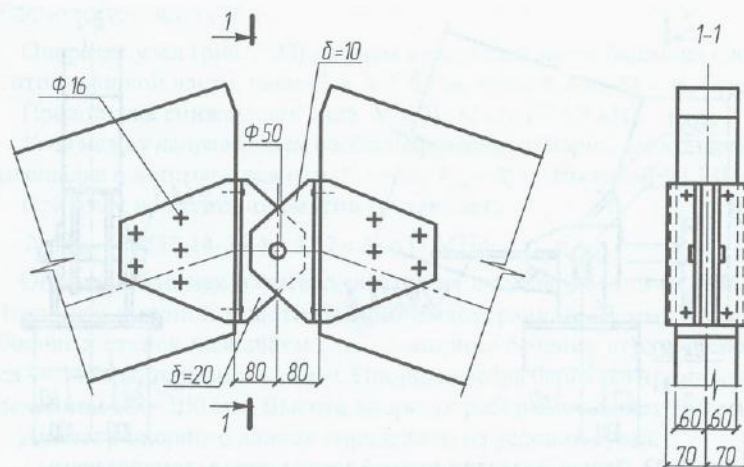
Коньковый узел треугольной арки с клееным армированным верхним поясом
